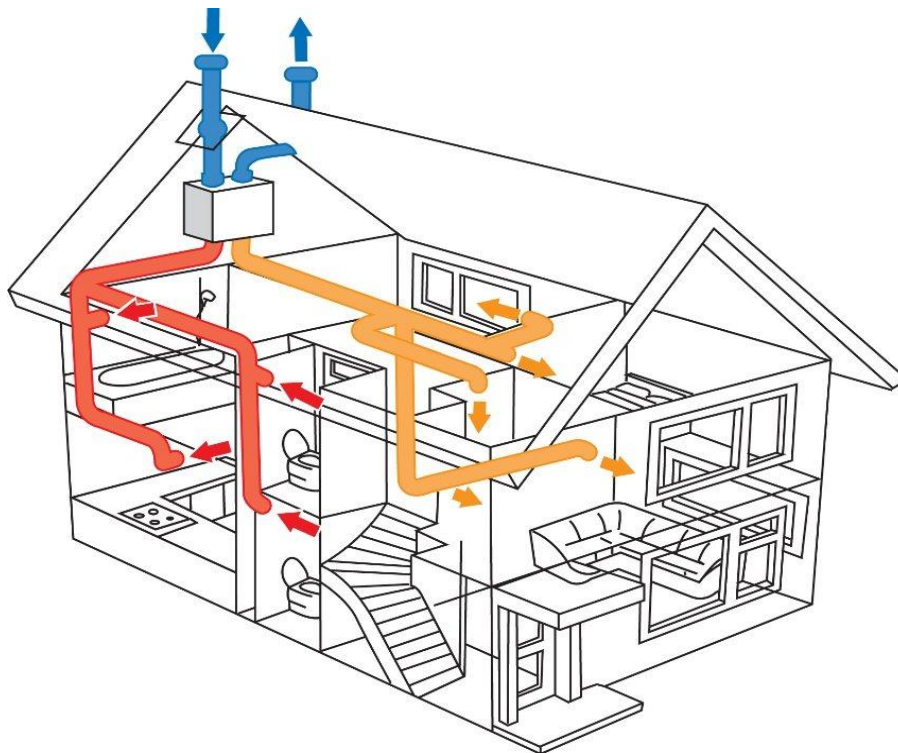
Схема размещения вентиляционных каналов внутри помещений
